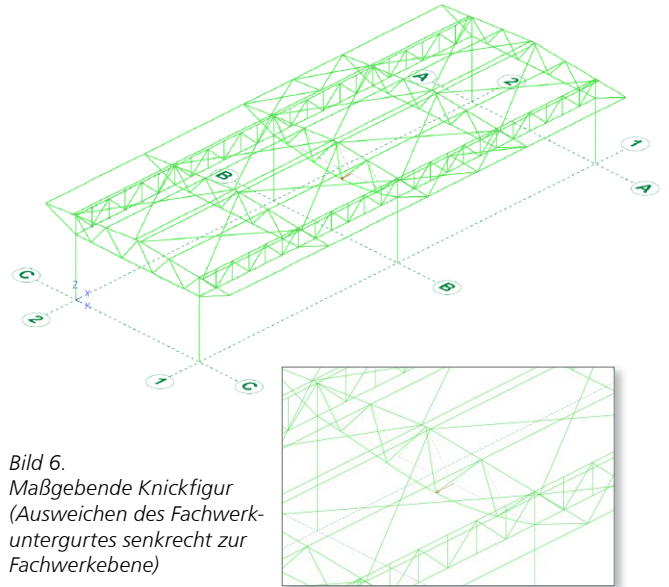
Maßgebende Knickfigur (Ausweichen des Fachwerkuntergurtes senkrecht zur Fachwerkebene)
